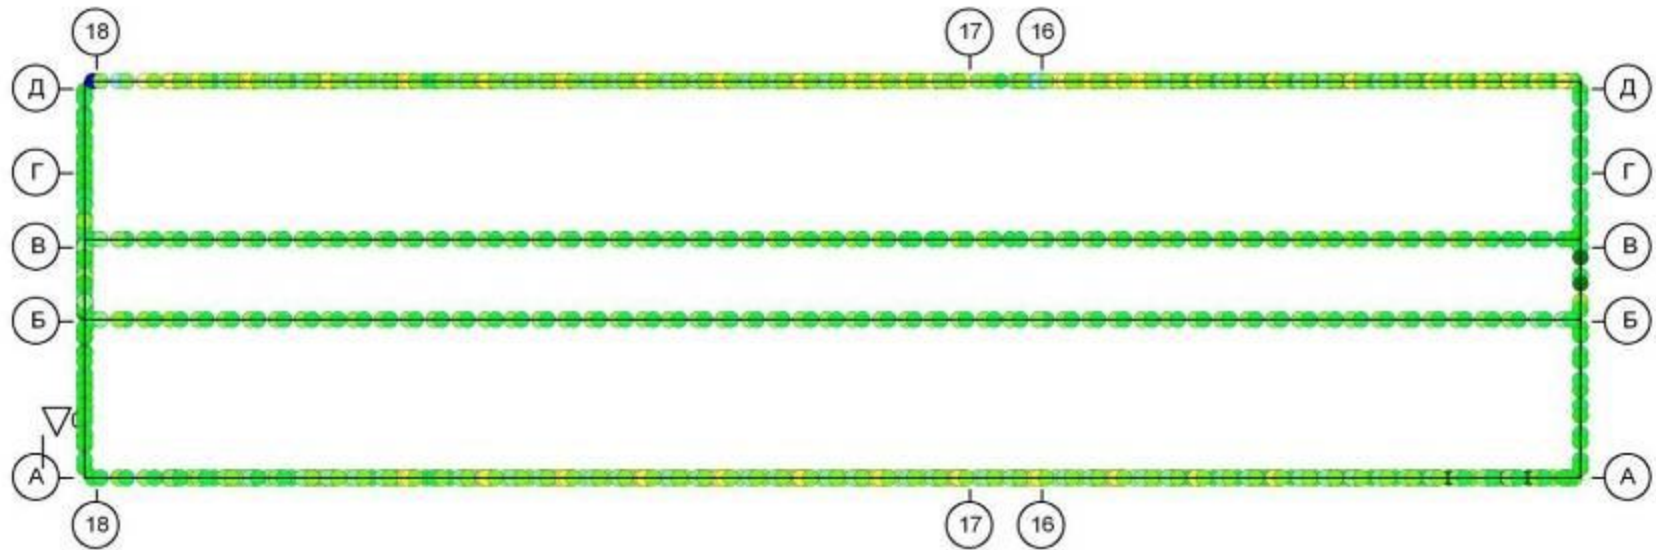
Нагрузка от наружных стен на ленточные фундаменты здания в осях «18-15/А-Д» от комбинации загрузений С5, тхм².
